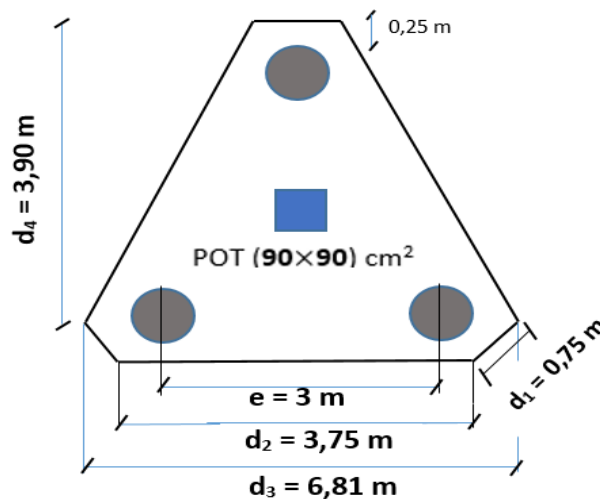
Dimensions finales de la semelle sur trois pieux
